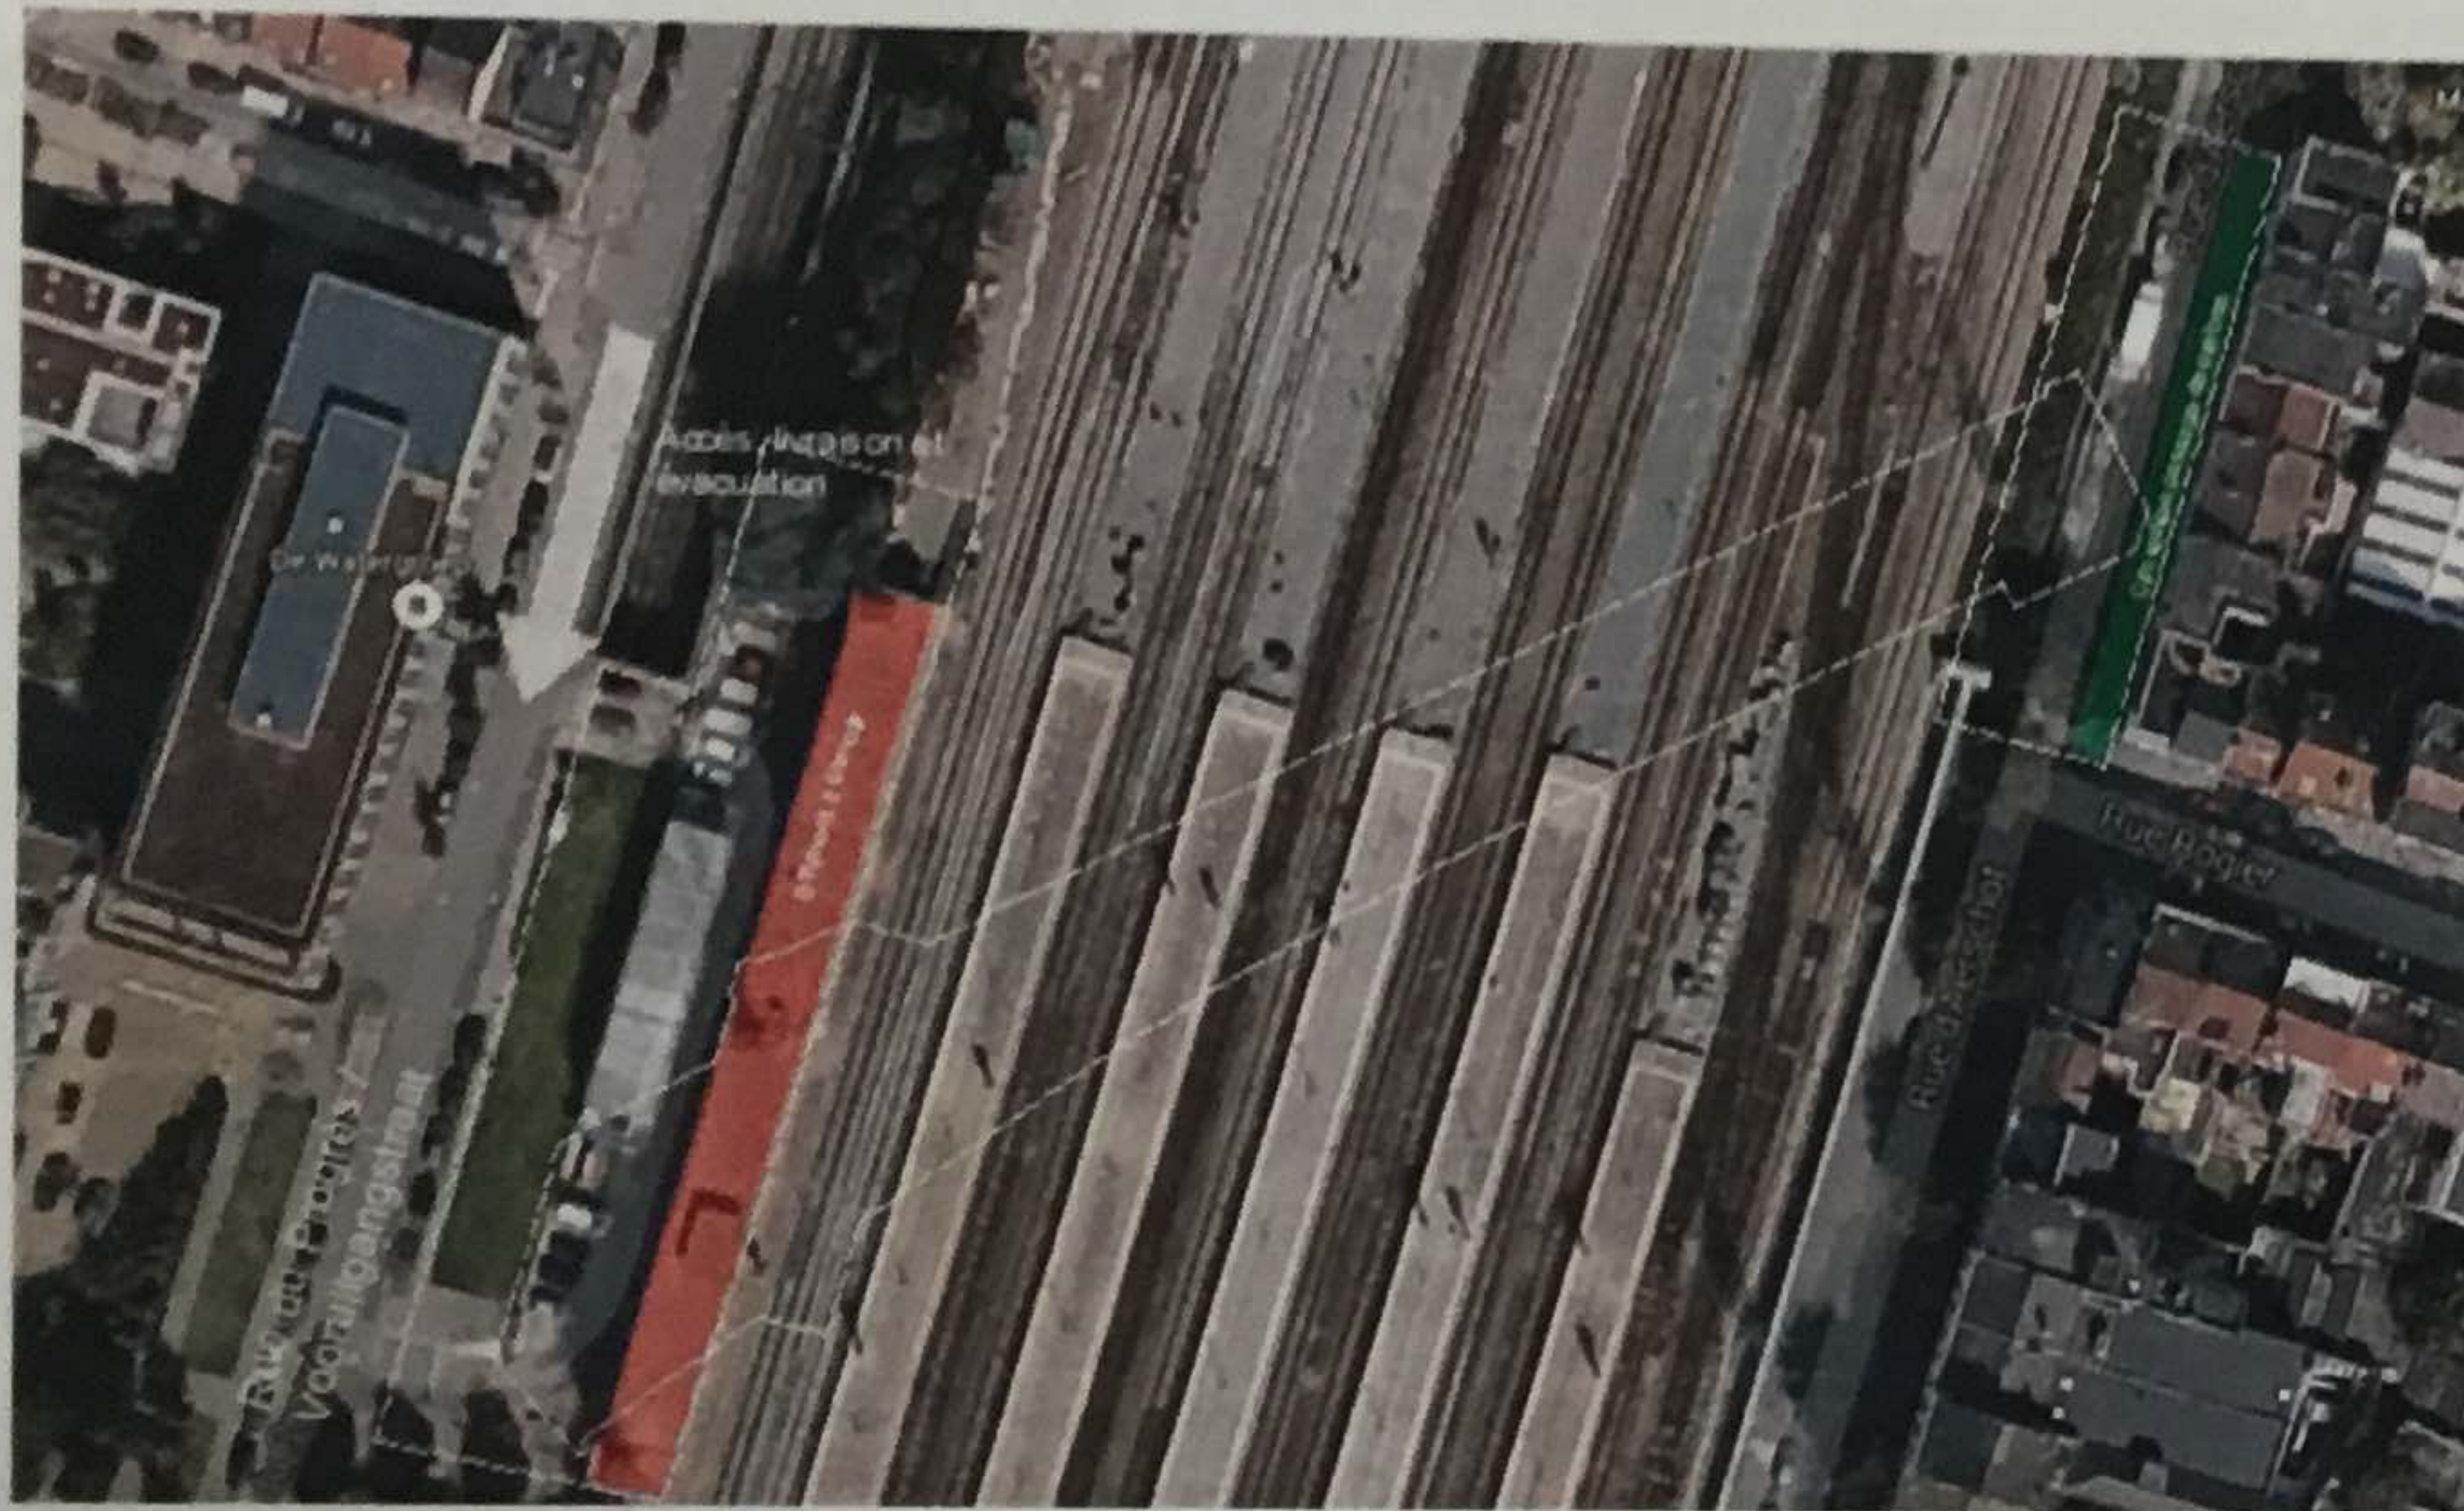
Implantation du chantier de la Gare du Nord, emprise chantier et accès
